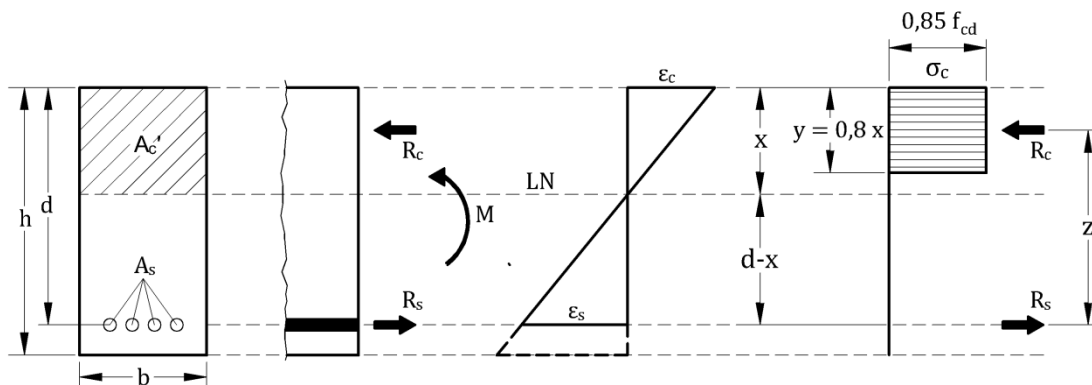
Distribuição de tensões e deformações em viga de seção retangular com armadura simples
